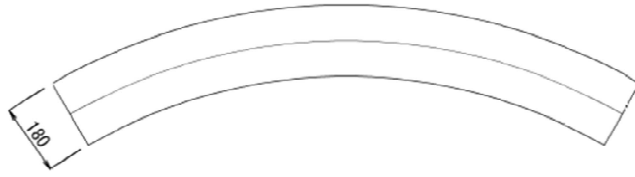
セグメント標準断面図（円周方向）（鉄筋コンクリート造）
